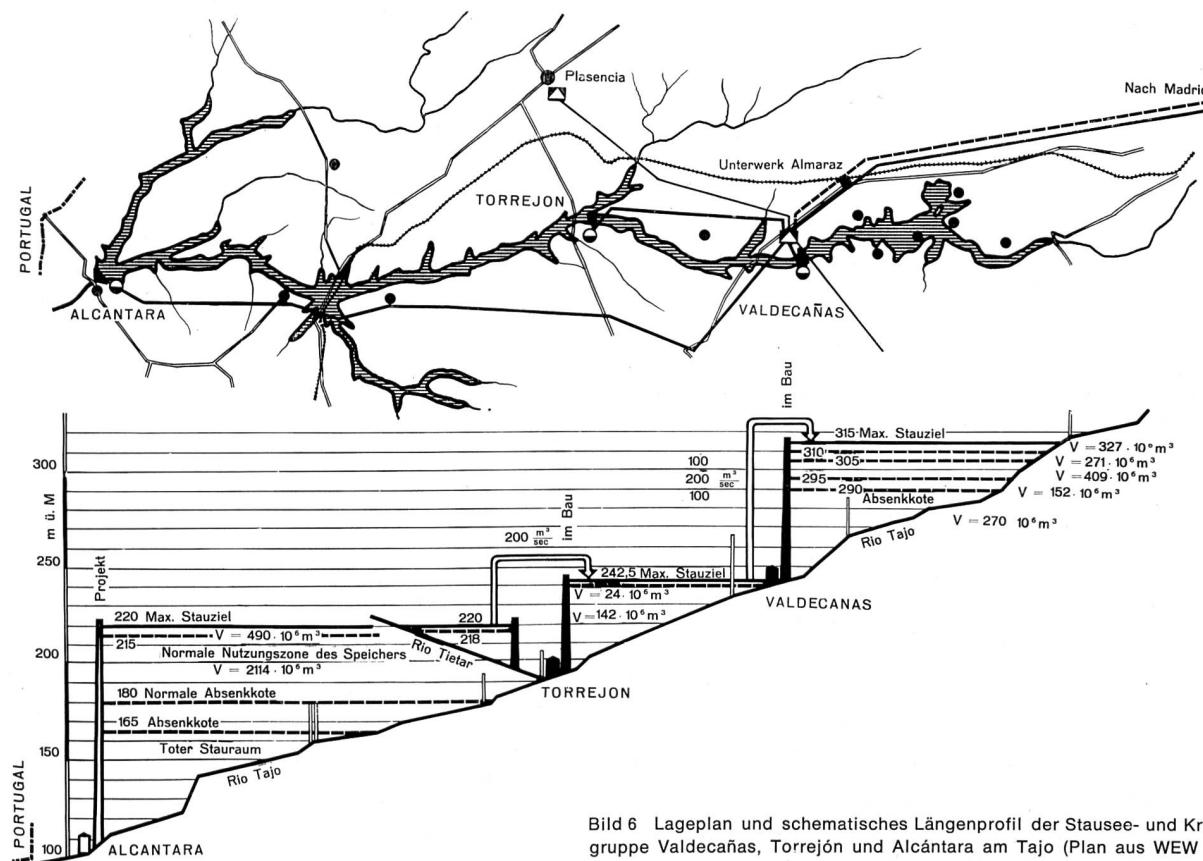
Lageplan und schematisches Längenprofil der Stausee- und Kraftwerkgruppe Valdecañas, Torrejón und Alcántara am Tajo (Plan aus WEW 1961)
